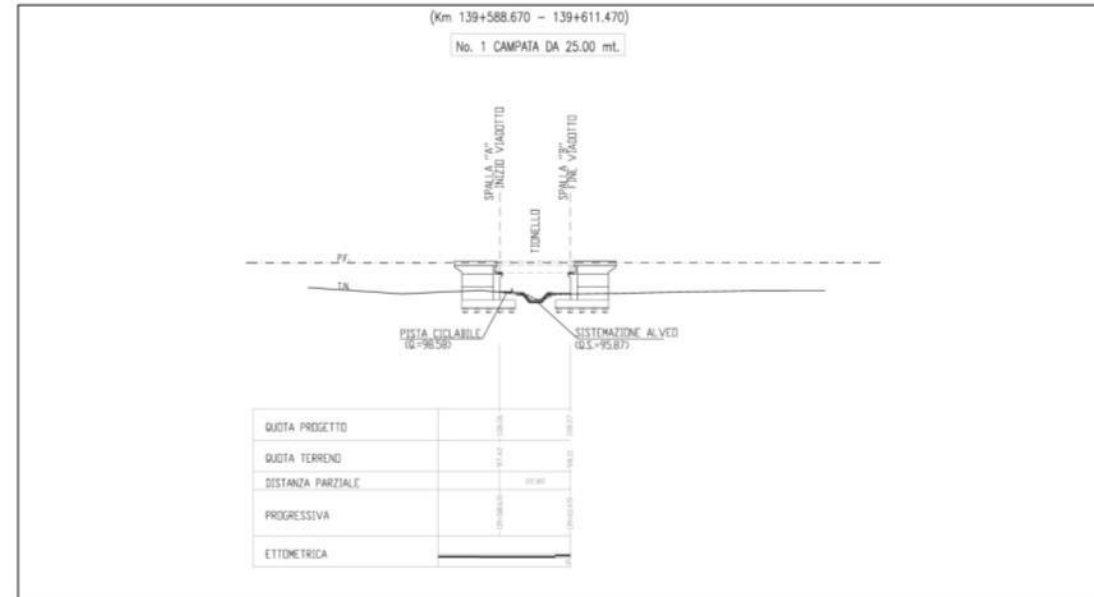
stralcio planimetrico e prospetto longitudinale – Viadotto Tione
